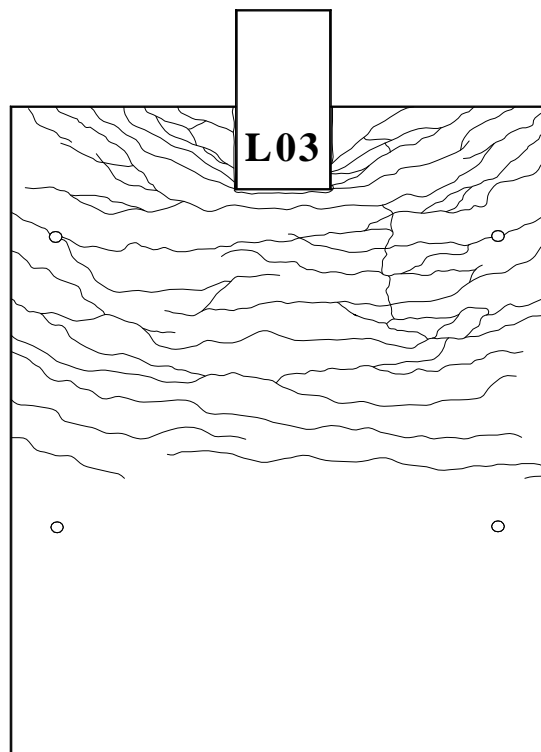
Padrão de fissuração da face inferior da laje – L4
